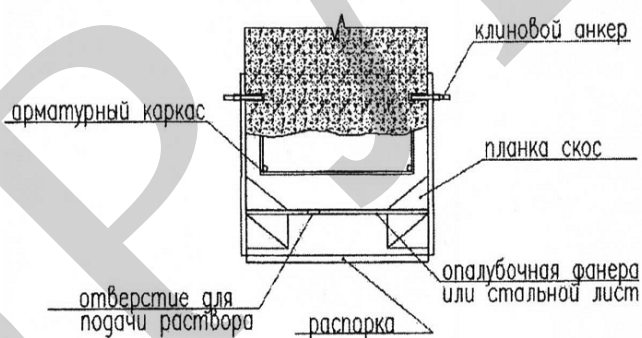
Передвижная опалубка из досок или фанеры
